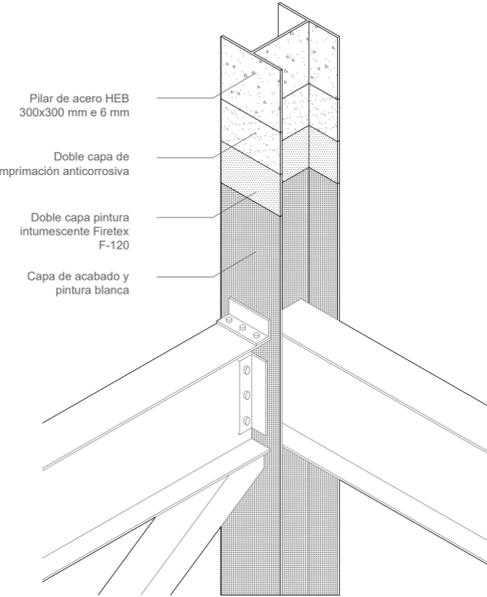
Capas de protección de la estructura. Fuente: Elaboración propia
